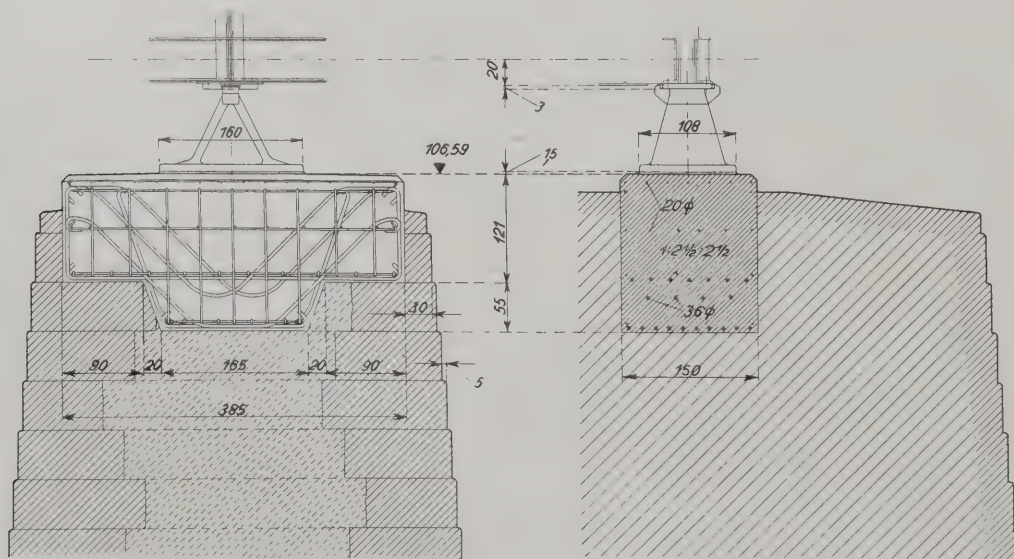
und 44. Quer- und Längsschnitt der Strompfeiler D und E mit den neuen Eisenbeton-Auflagerquadern.
